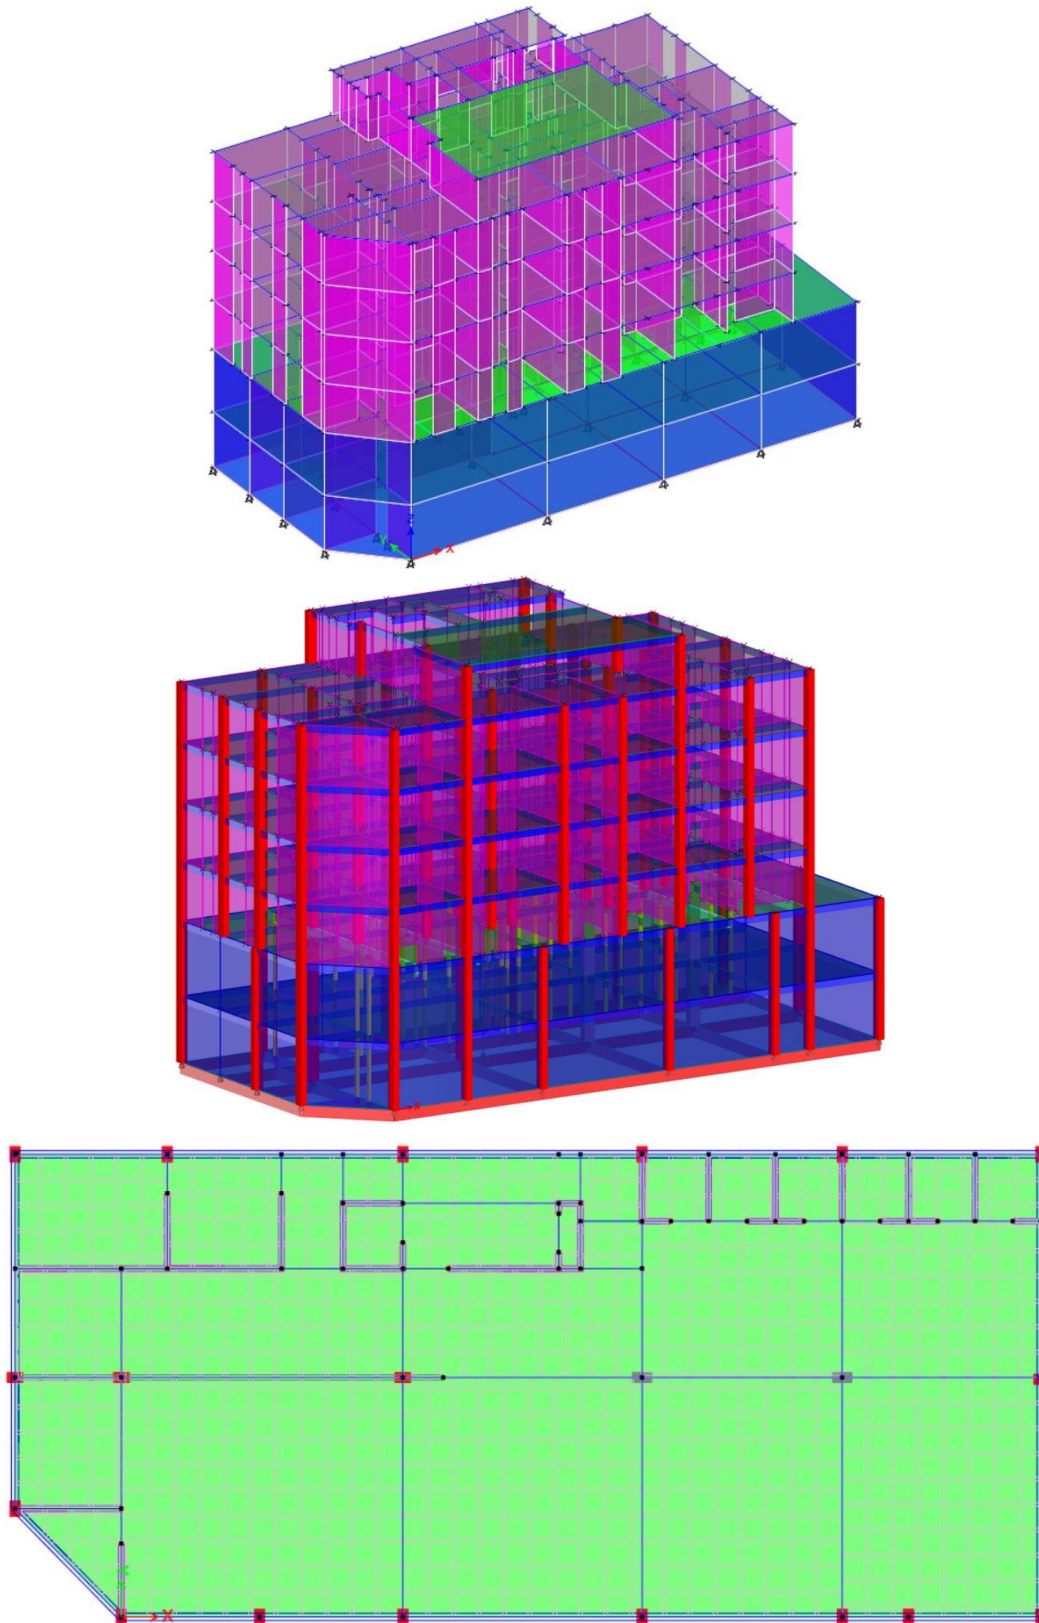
ISOMETRICOS Y PLANTA DEL MODELO ESTRUCTURAL
